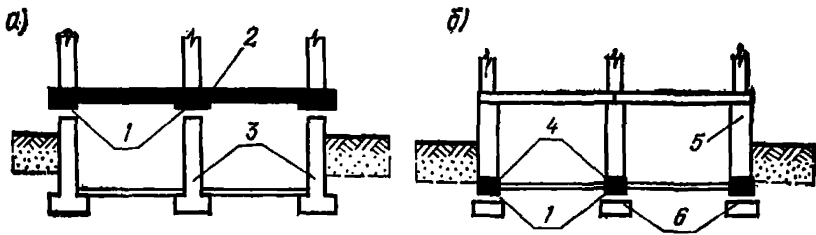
Варианты конструктивных решений фундаментно-подвальной части зданий
